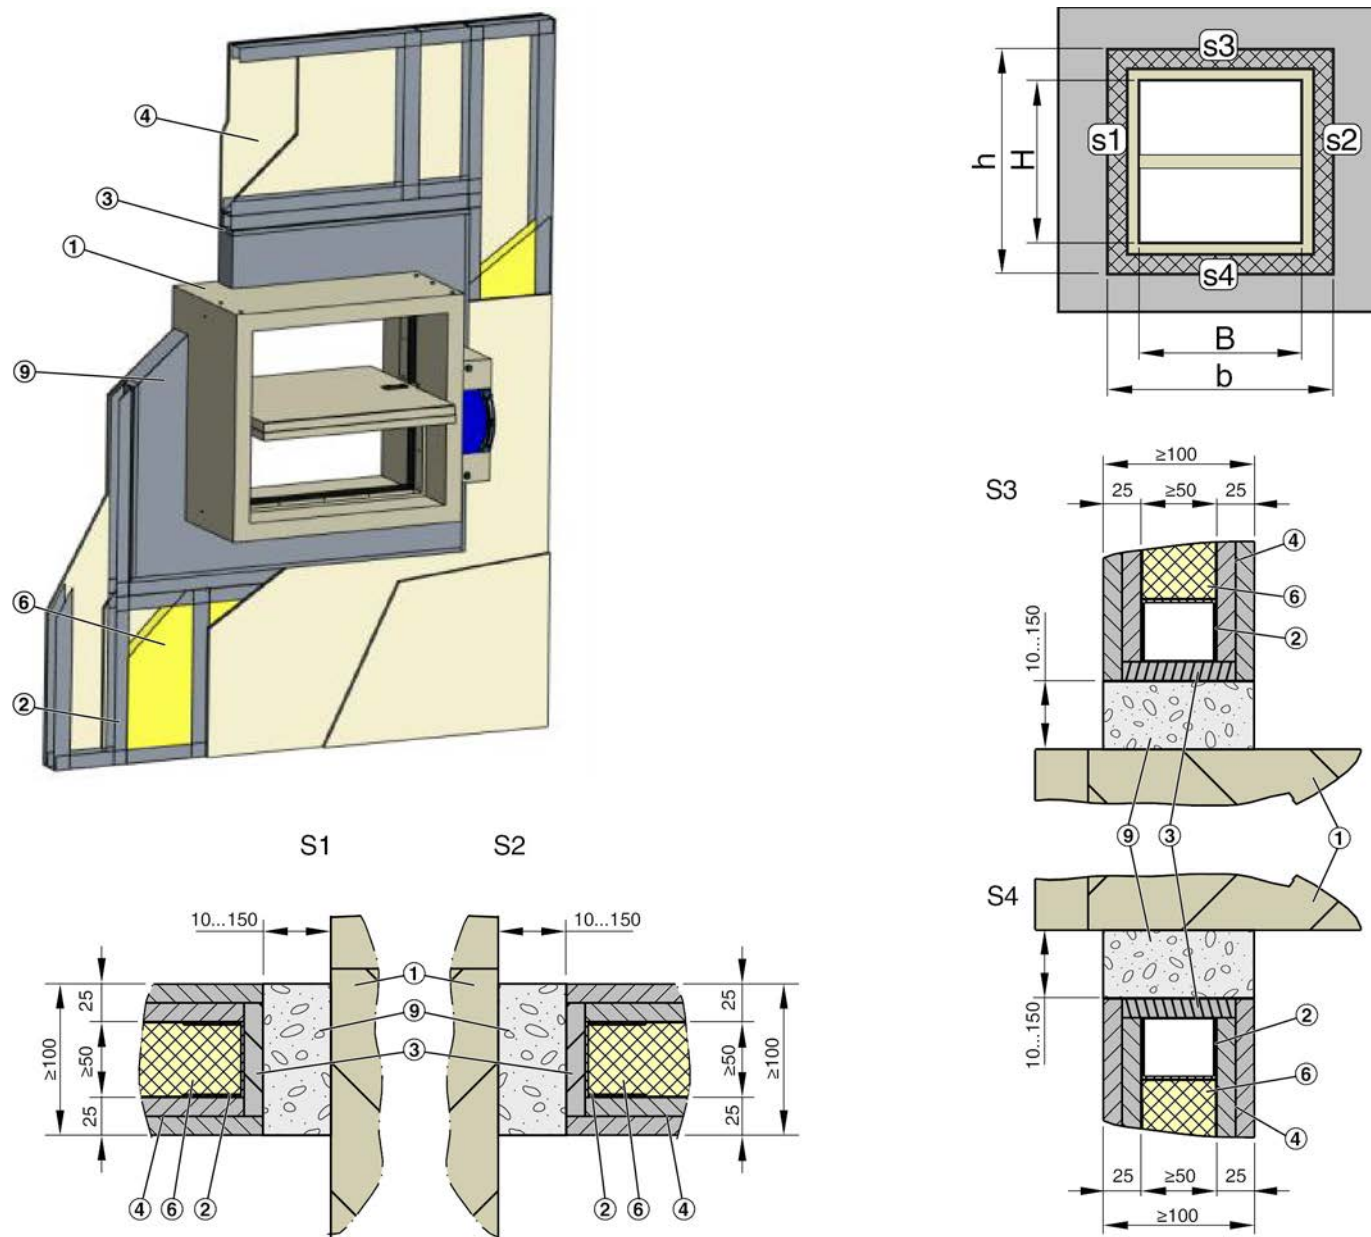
Installazione senza muratura in parete divisoria leggera, variante di installazione b, indice di classificazione:  $V_{ew}$
